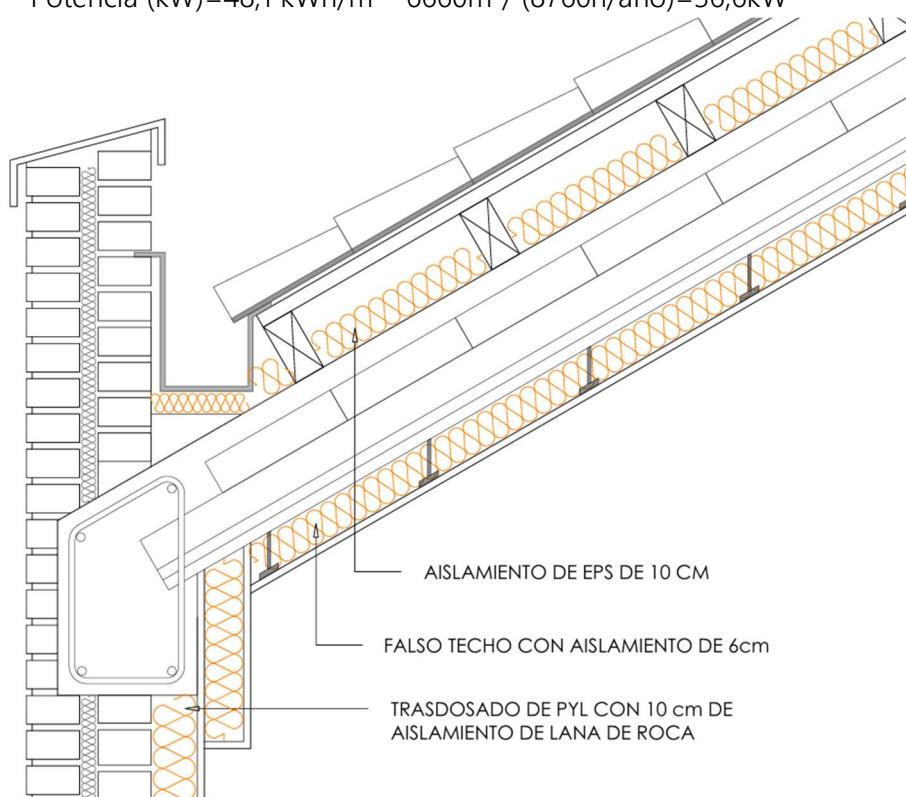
DETALLE PROPUESTA CUBIERTA INCLINADA CEIP INFANTAS ELENA Y CRISTINA
